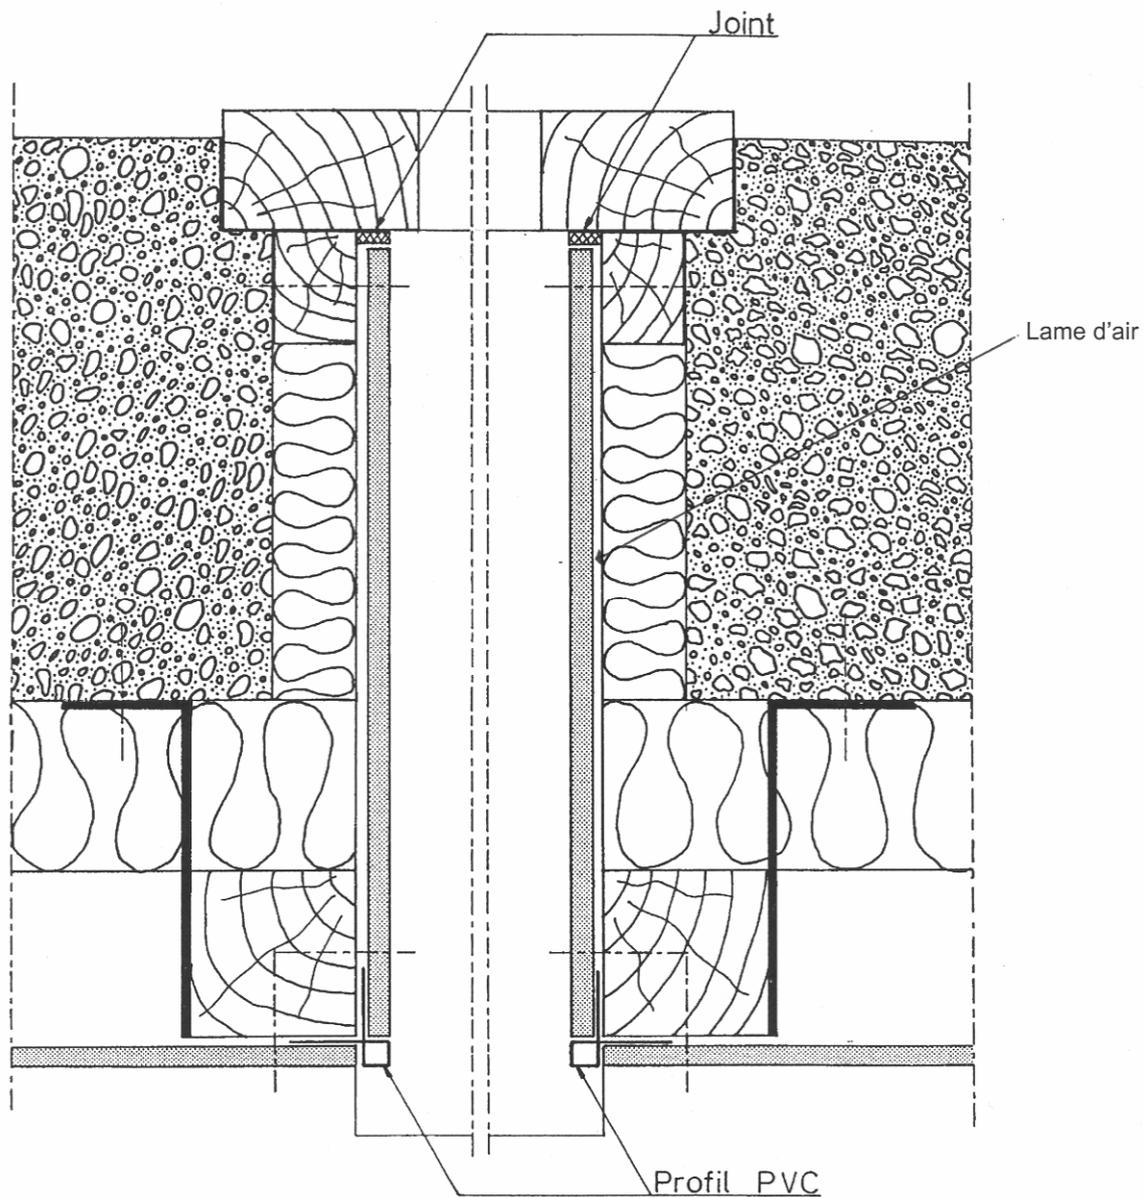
Encadrement de baie avec isolation complémentaire – coupe horizontale - Pose en bardage
